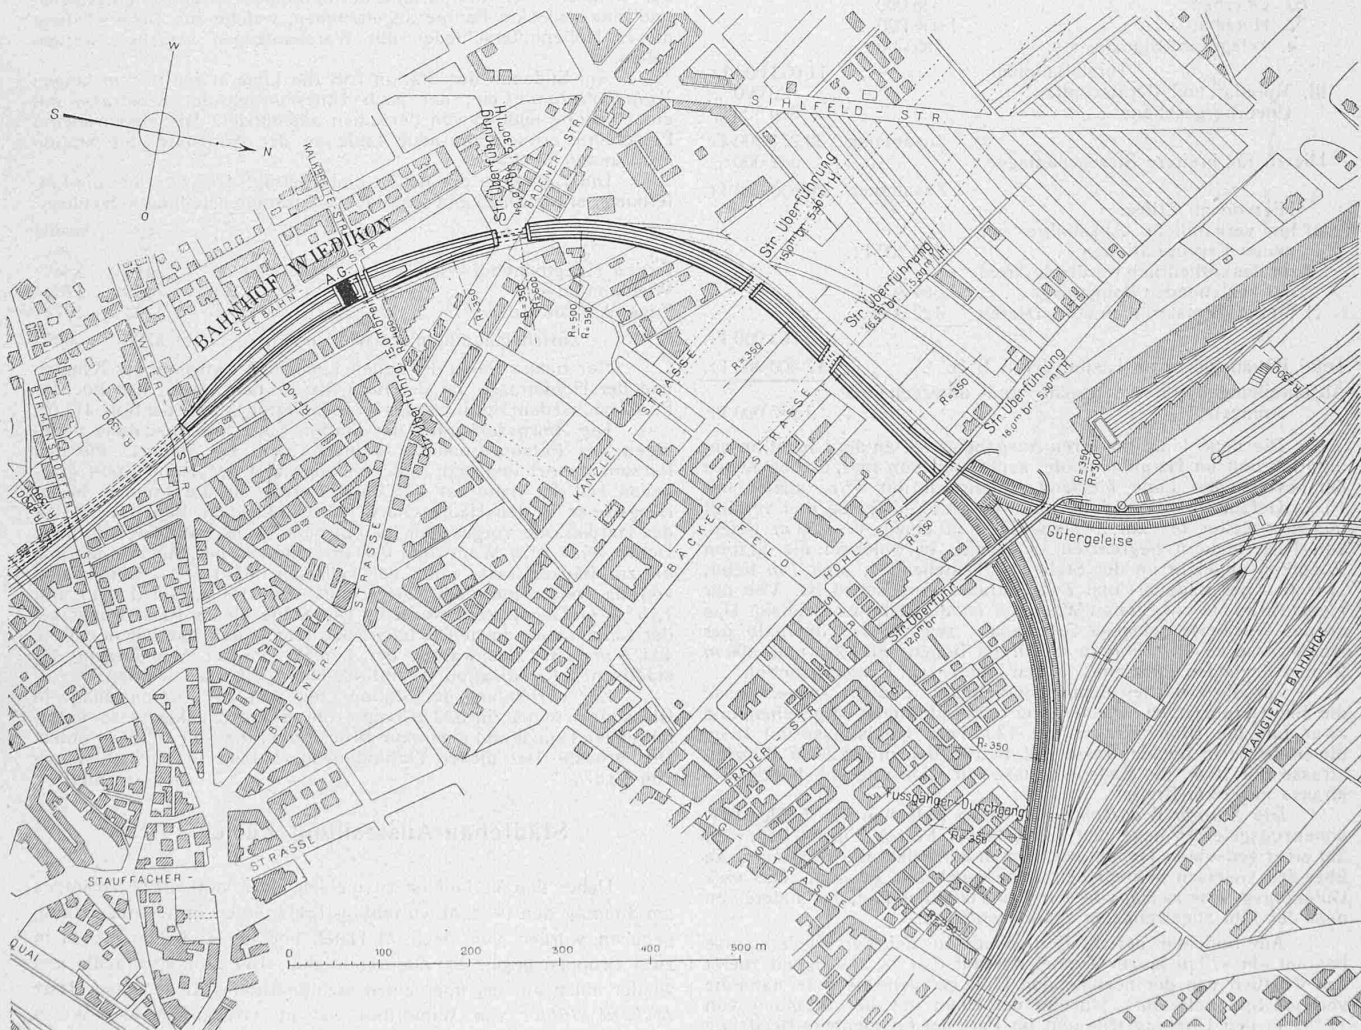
Lageplan von der Station Wiedikon bis zur Langstrassen-Unterführung. — Masstab 1:7500.
